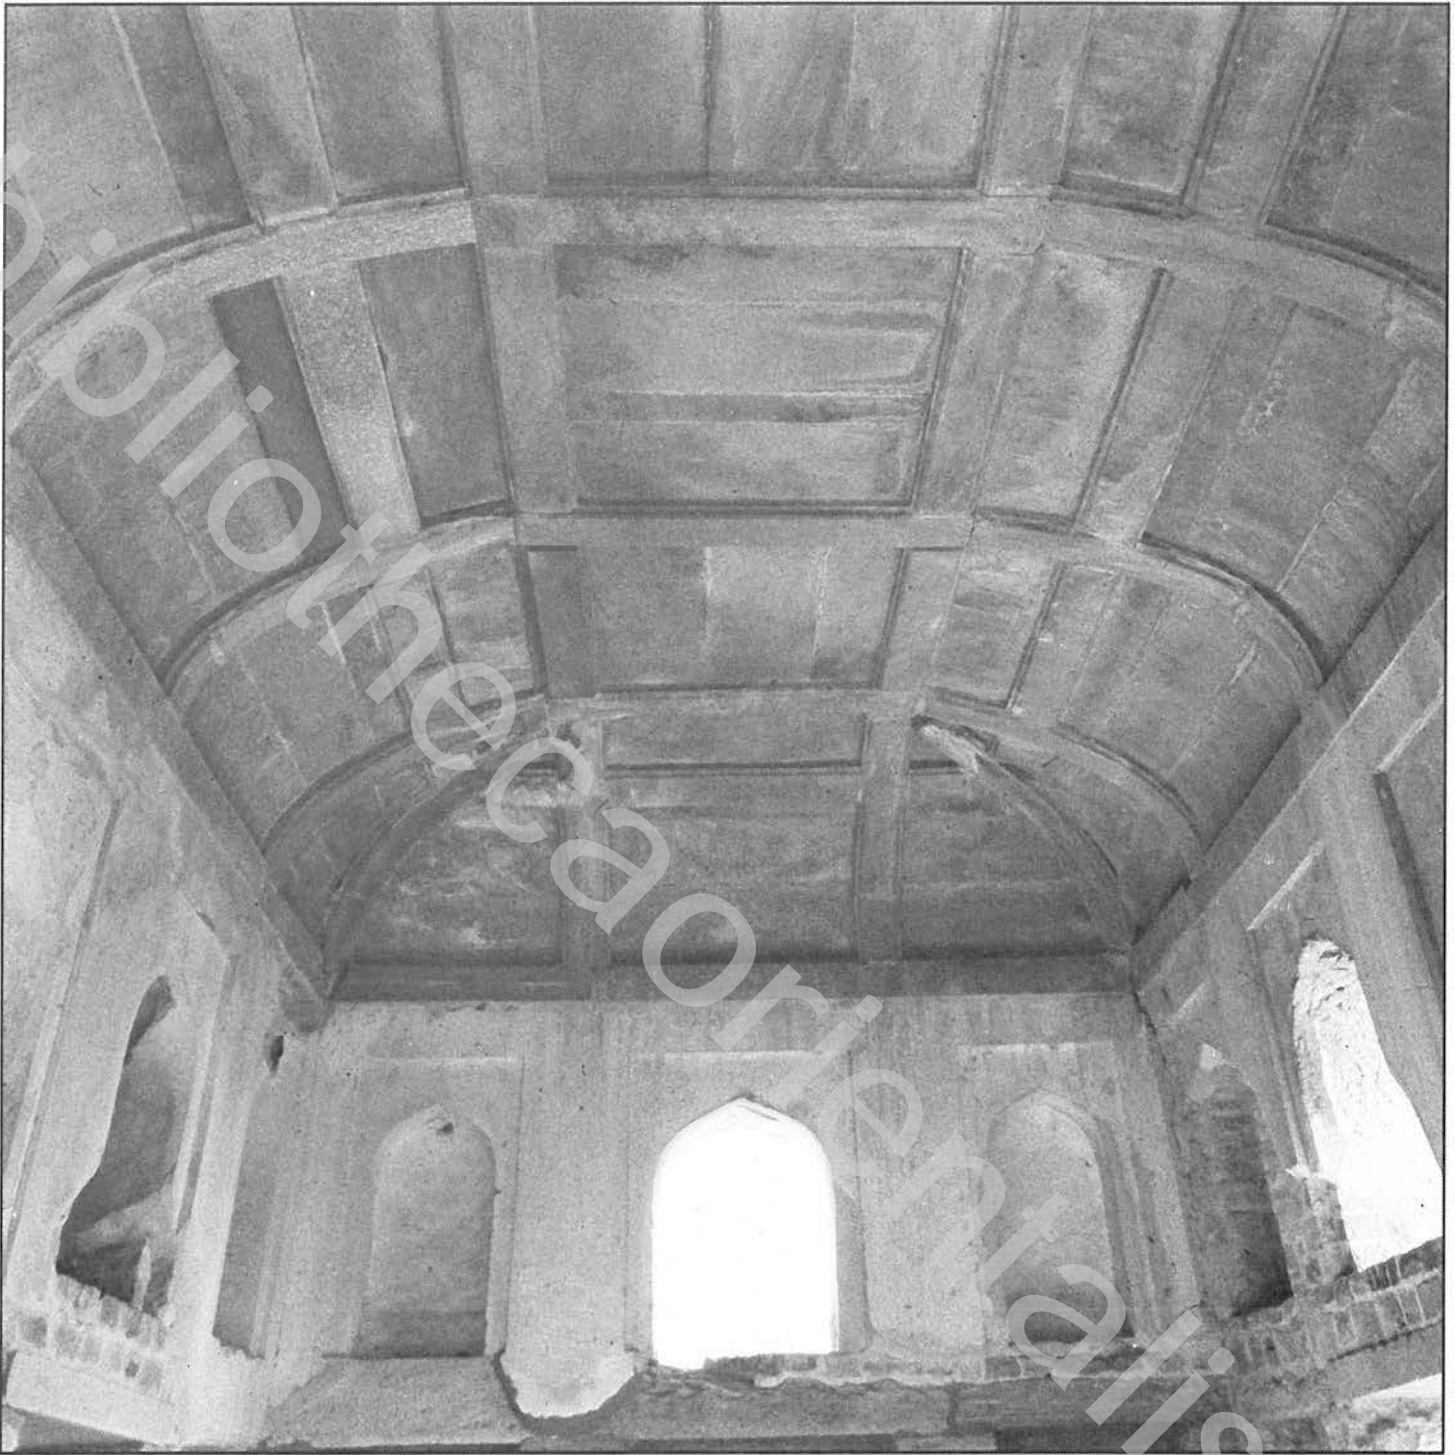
Casa detta di Abul Fazl, la veranda. Grande vano a tutta altezza in cui si affacciano gli ambienti della casa. Struttura costruita interamente a secco con travi, pilastri e lastre di *sang-i-surkh*, fermate con grappe metalliche. Il soffitto piano di lastre di pietra battentate, tessuto tra il muro della sala e la trabeazione di colonne binate, è capace di grandi luci. v. anche il Badi Mahal alle figg.
